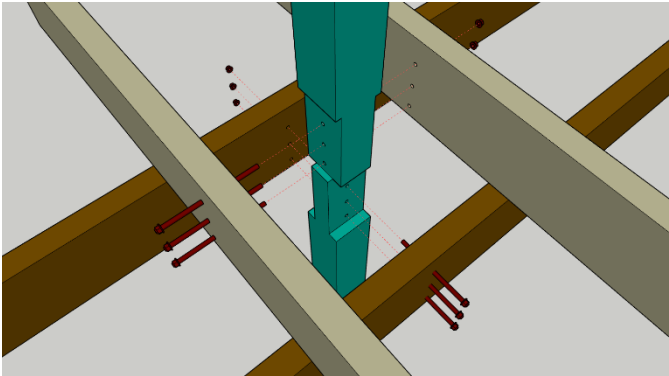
Узел опирания обвязочных балок и балок покрытия на колонну
